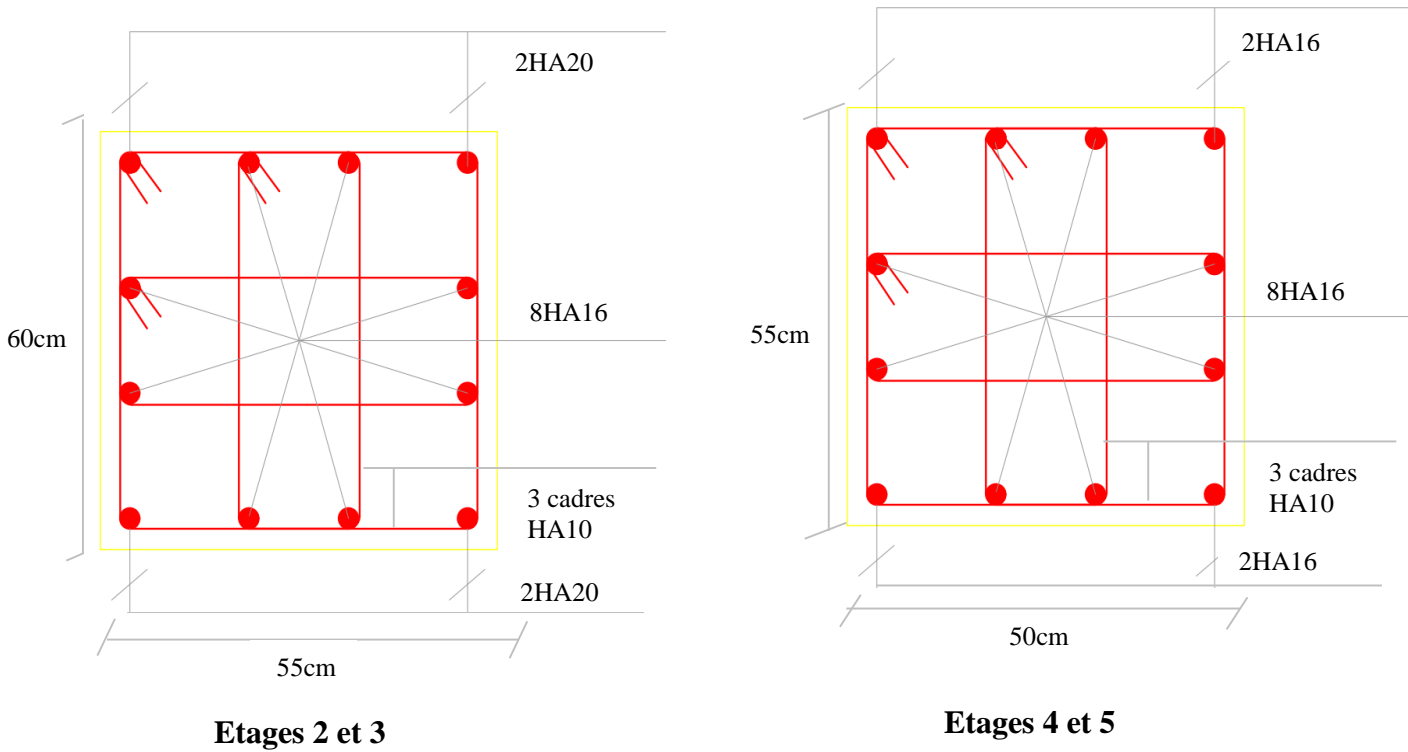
Schéma de ferrailage des poteaux d'étages 2,3,4,5
